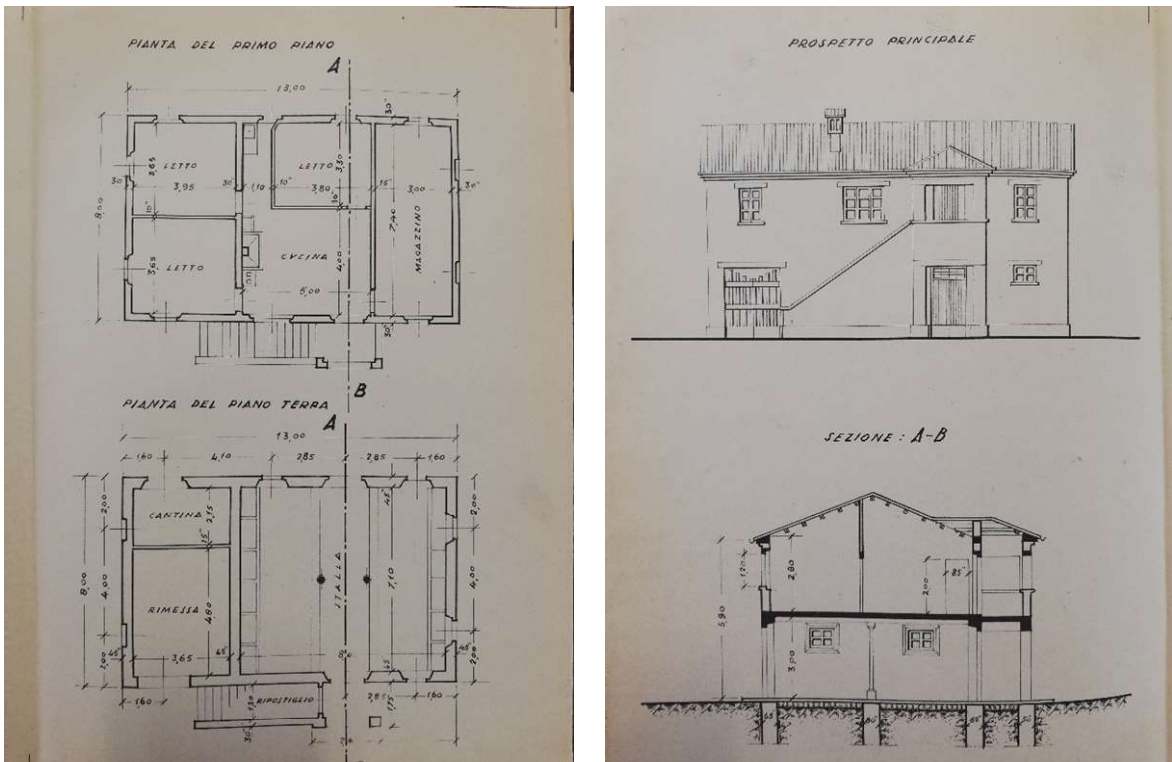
Disegni di progetto: piante, sezione e prospetto (fonte: *archivio di Stato di Ancona, busta 112, pratica 374*)
